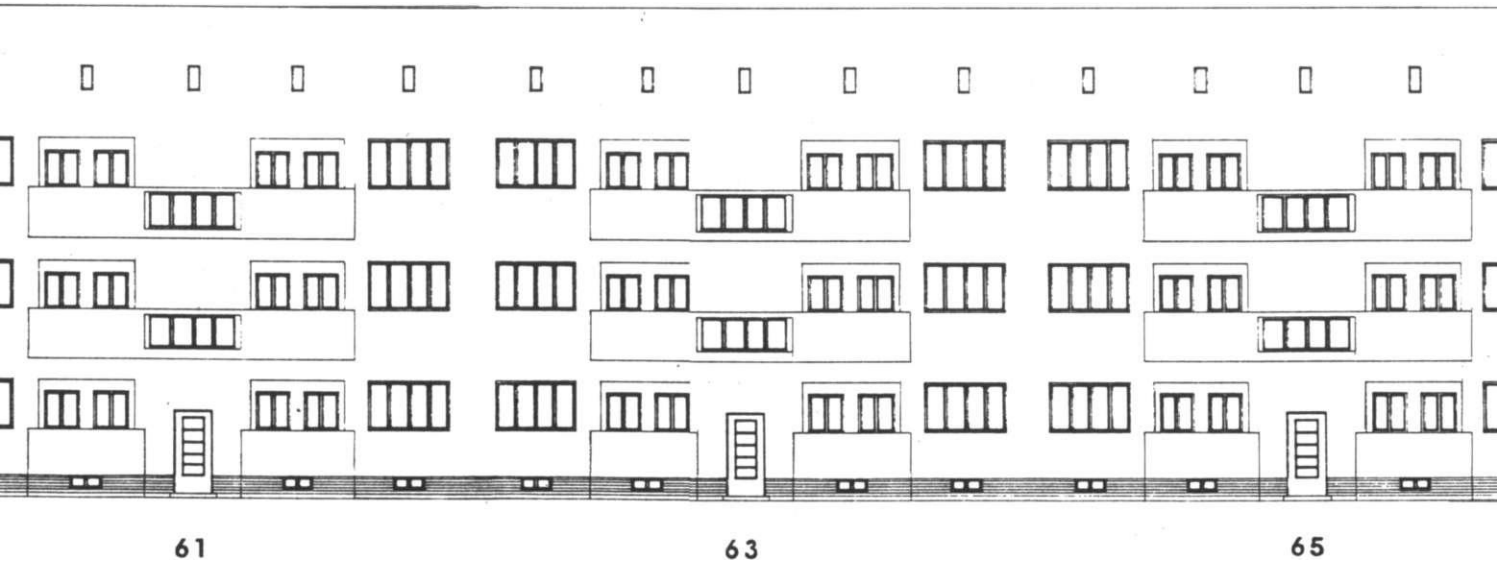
1929. Wörlitzer Straße Ecke Jerichower Straße.
